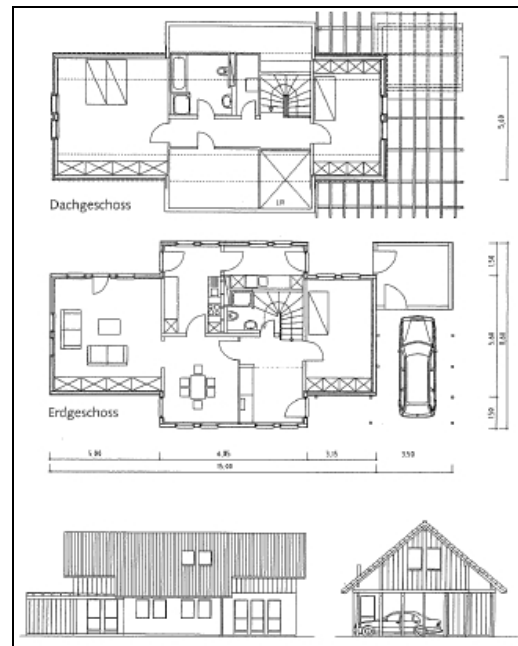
Ansicht und Grundriss für die betrachteten Beispielgebäude
